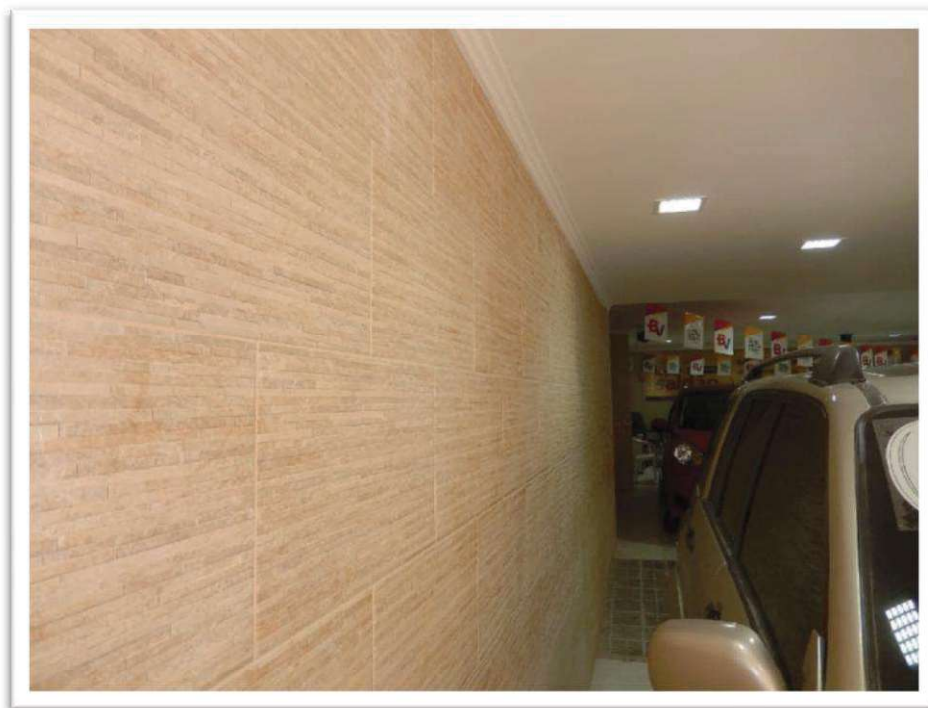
Vista parcial do pavimento térreo do Imóvel 1.
